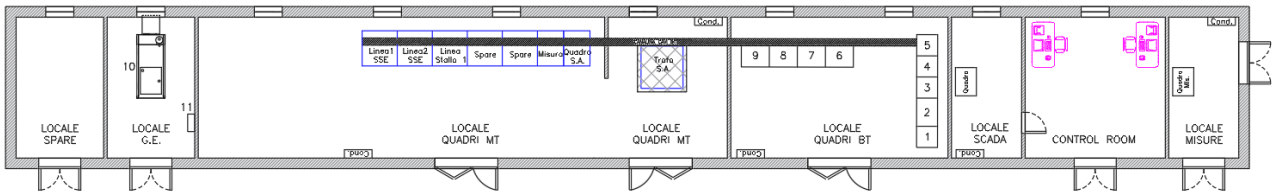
Stazione Elettrica Utente Stallo 1 – Planimetria
